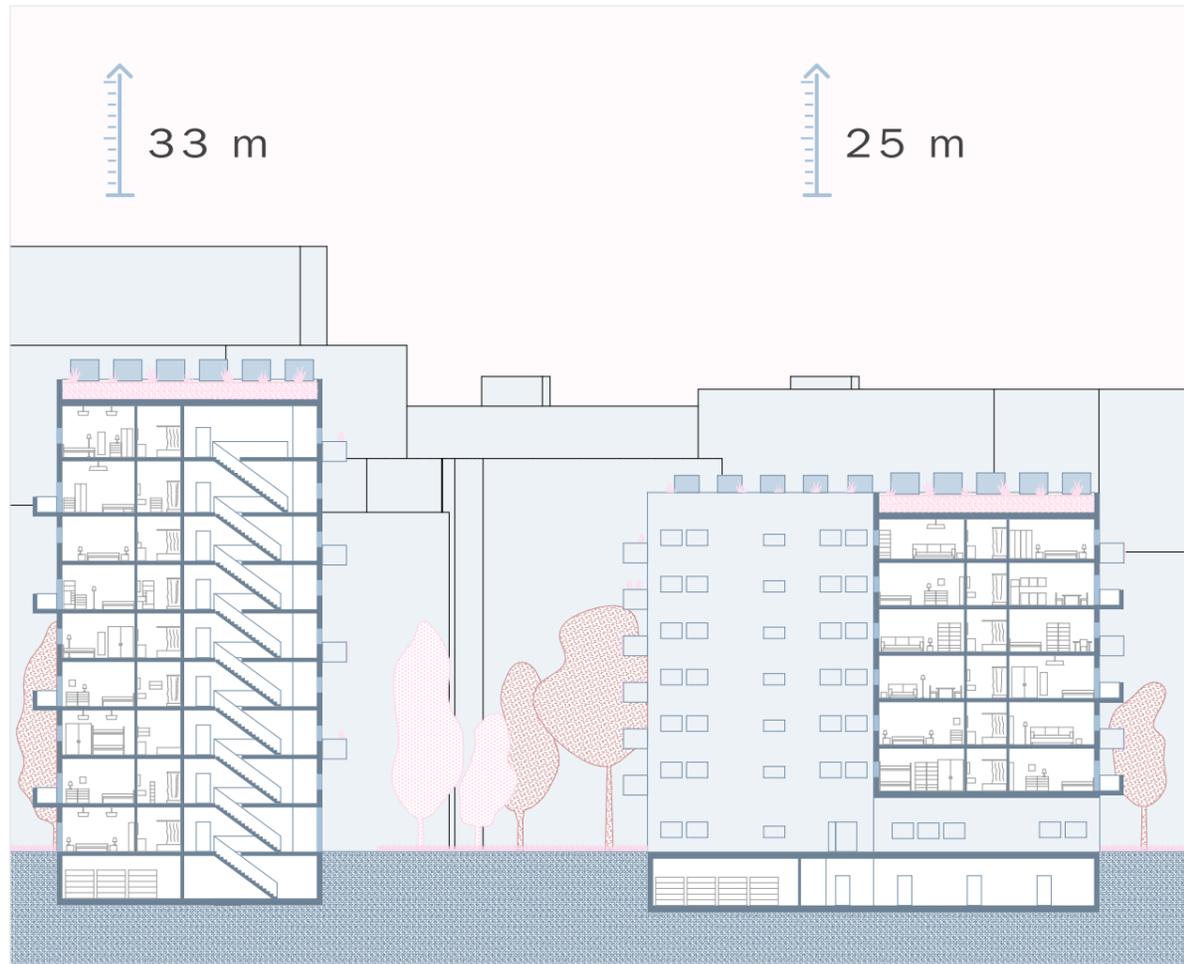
Schnitt durch Wohnbebauung in M 1:500
